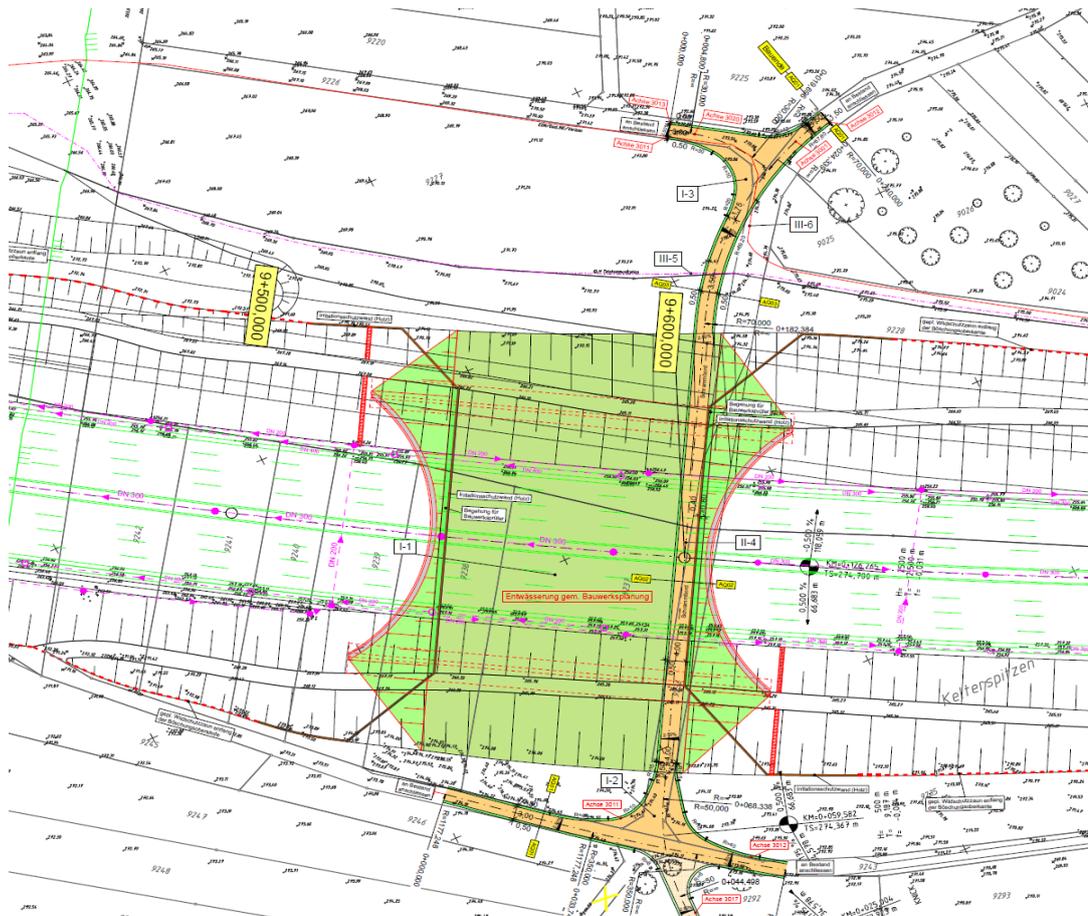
Ausschnitt aus dem Lageplan zu Variante 3, einfache Zuwegung auf die Brücke
